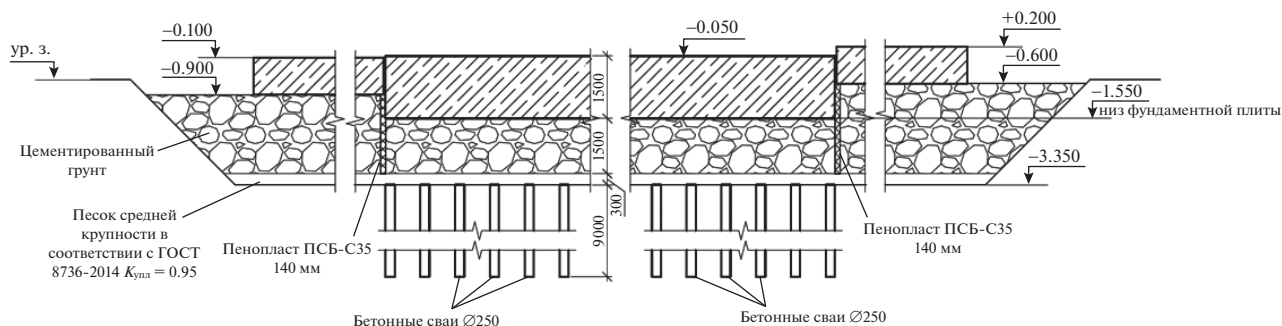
Конструкция фундамента и оснований зданий ускорительного комплекса и выносных станций.
